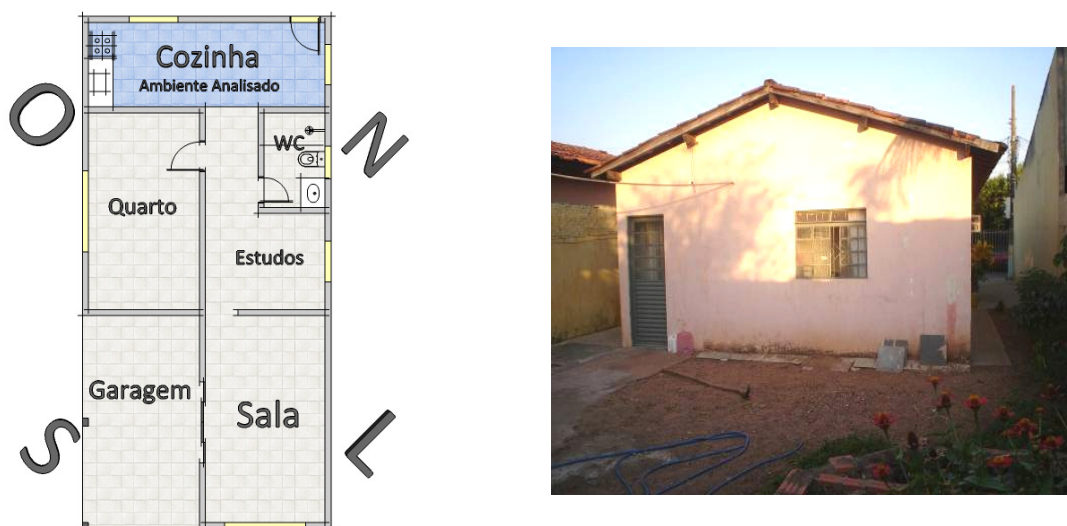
Localização do ambiente analisado e fachada da Casa 02
